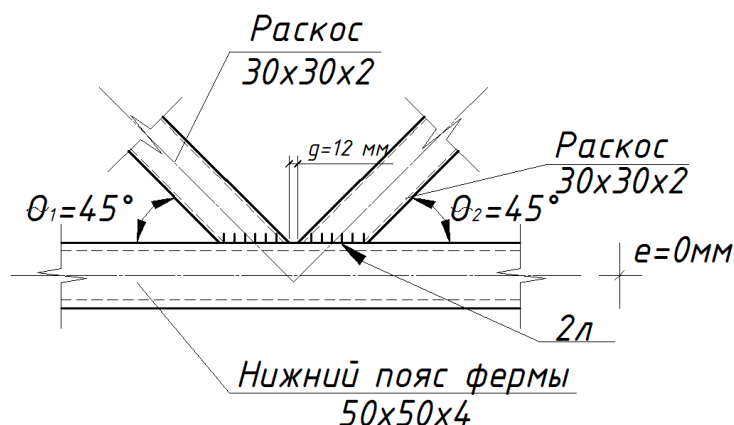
Схема сварного узла сопряжения раскосов и нижнего пояса в ферме
